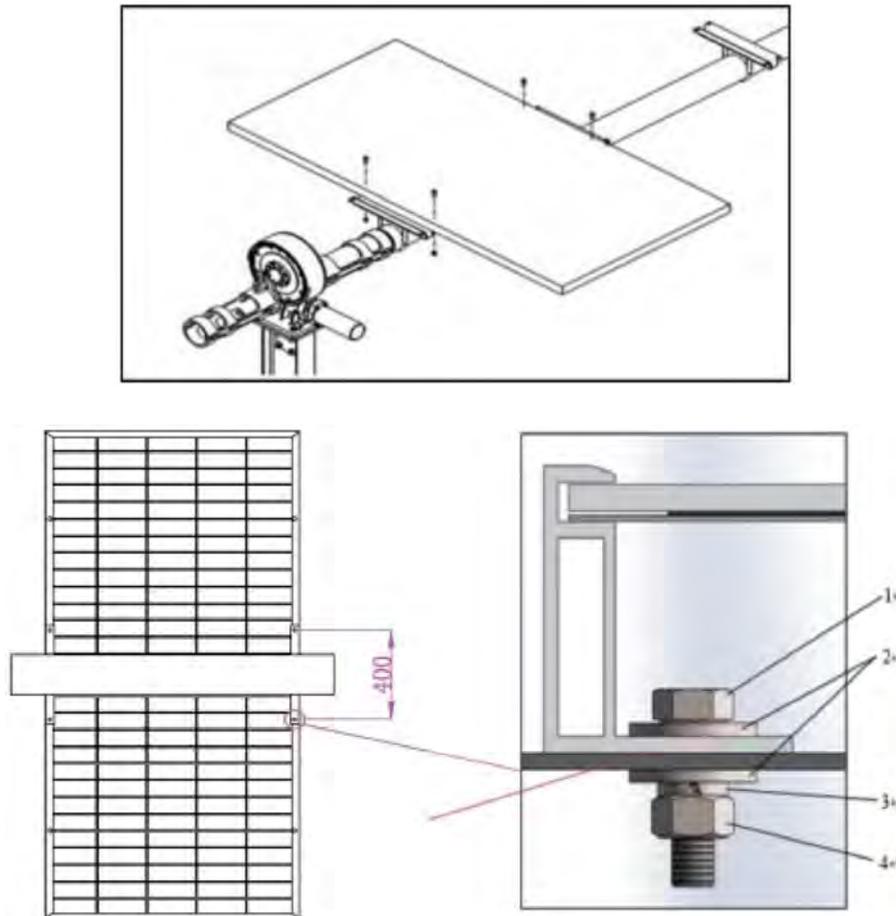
Installiertes PV-Modul mit einachsigen Nachführsystem
